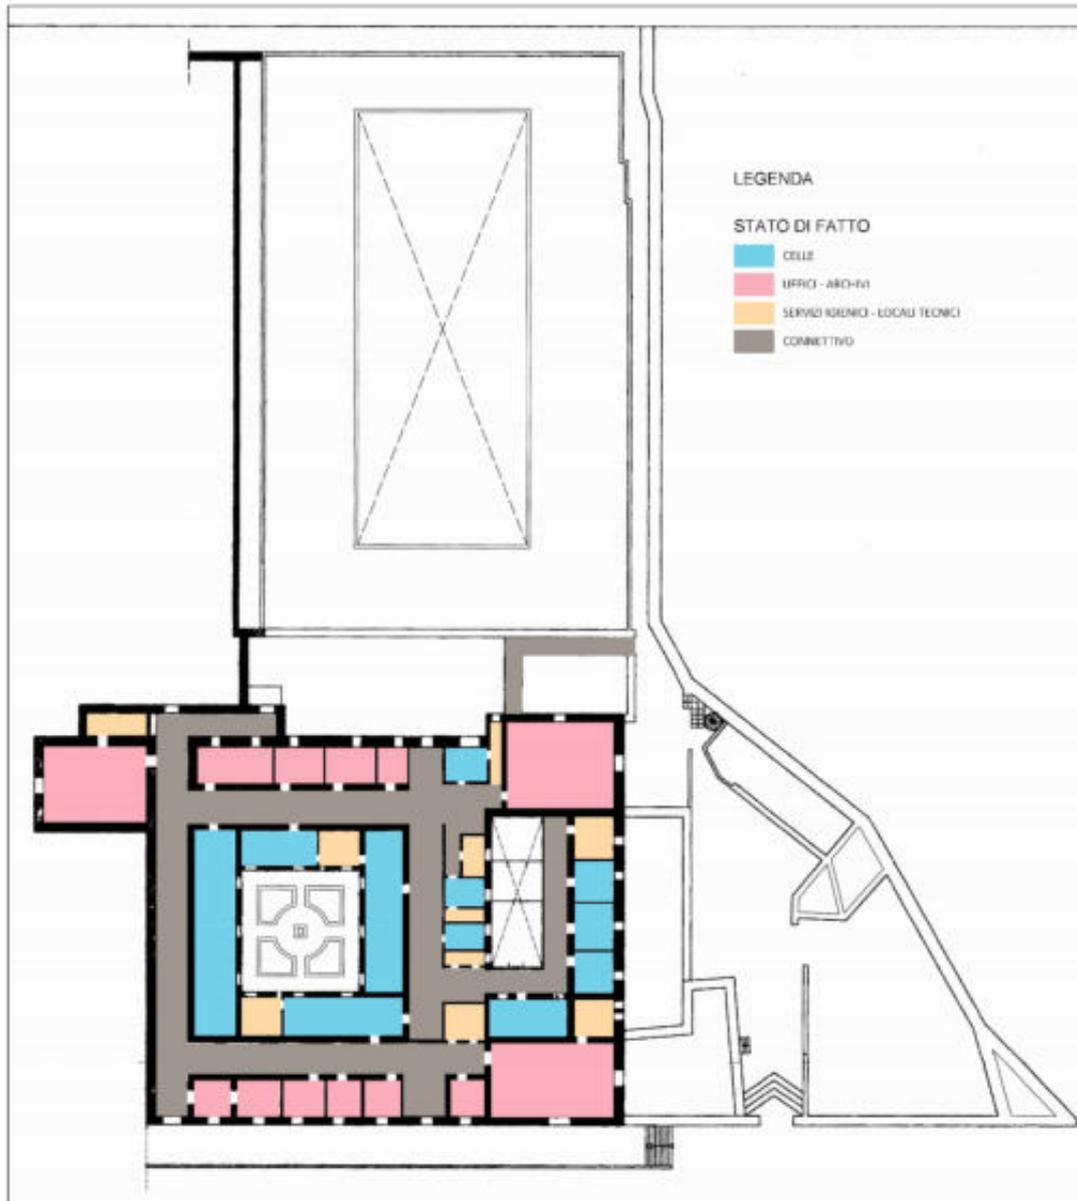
Pianta piano primo, destinazioni d'uso attuali
